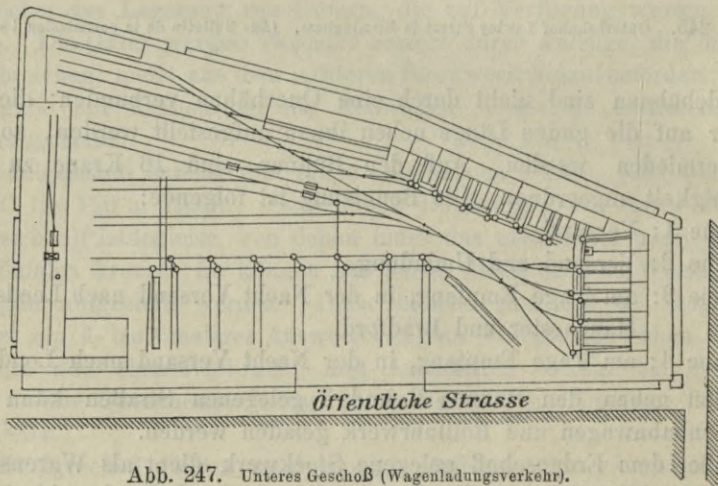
Unteres Geschoß (Wagenladungsverkehr).
